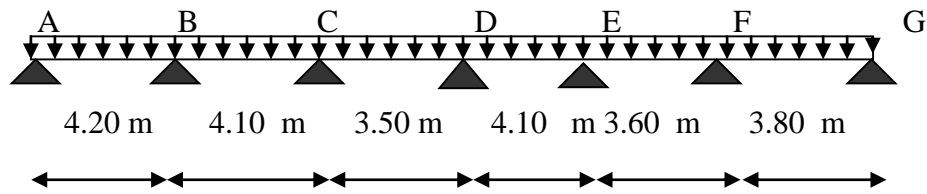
Schéma de la poutrelle de Type 1 de l'étage courant.
